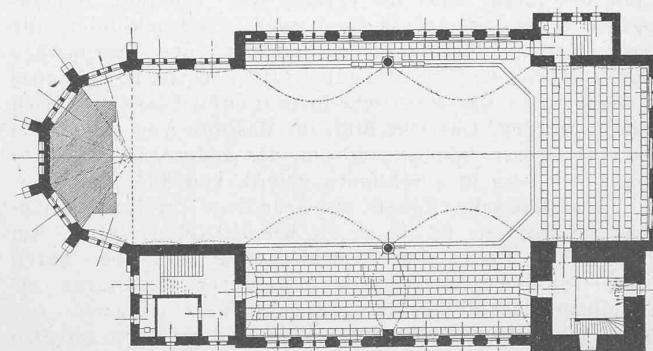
Grundriss der Empore. — Masstab 1:500.
